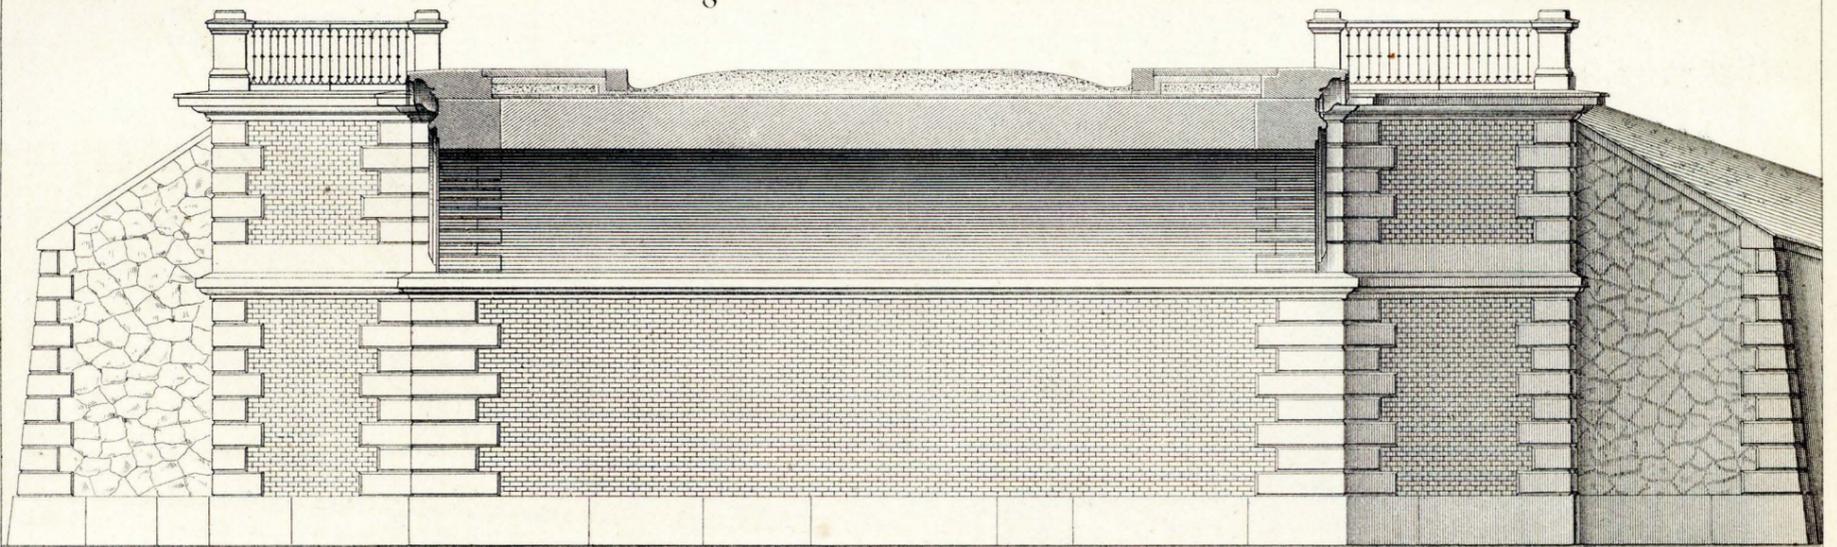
Pianta di una spalla coi muri d'ala
